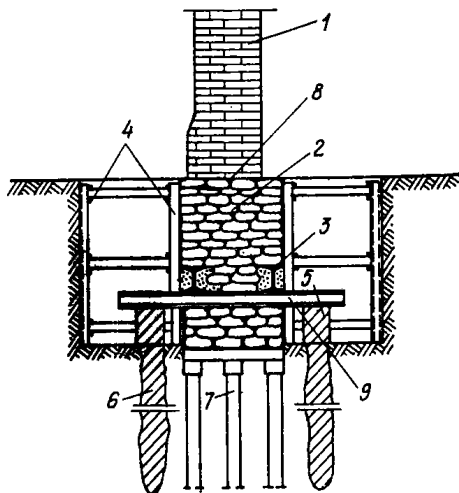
Усиление оснований зданий набивными длиномерными сваями
